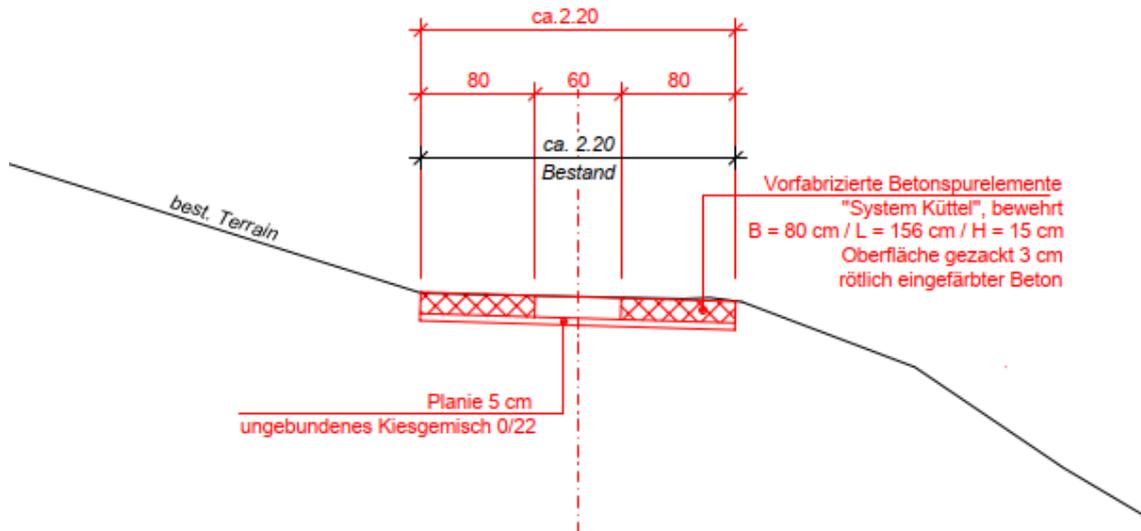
Normalprofil mit Einbau Betonelemente auf Bestand (ohne Verbreiterung), Hofzufahrt Heuberg
